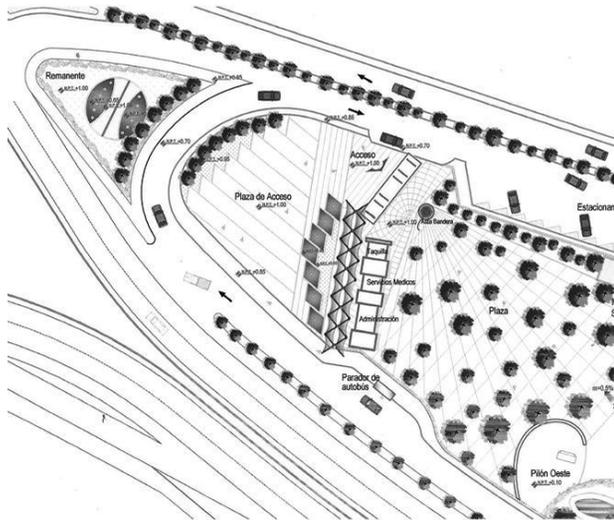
Imagen de fracción #1 de la planta arquitectónica lado Oeste donde se aprecia la plaza de acceso, el acceso mismo y la plaza perspectivada con el asta bandera, el área administrativa, la parada de autobús y el pílón Oeste del Parque Tresguerras.
